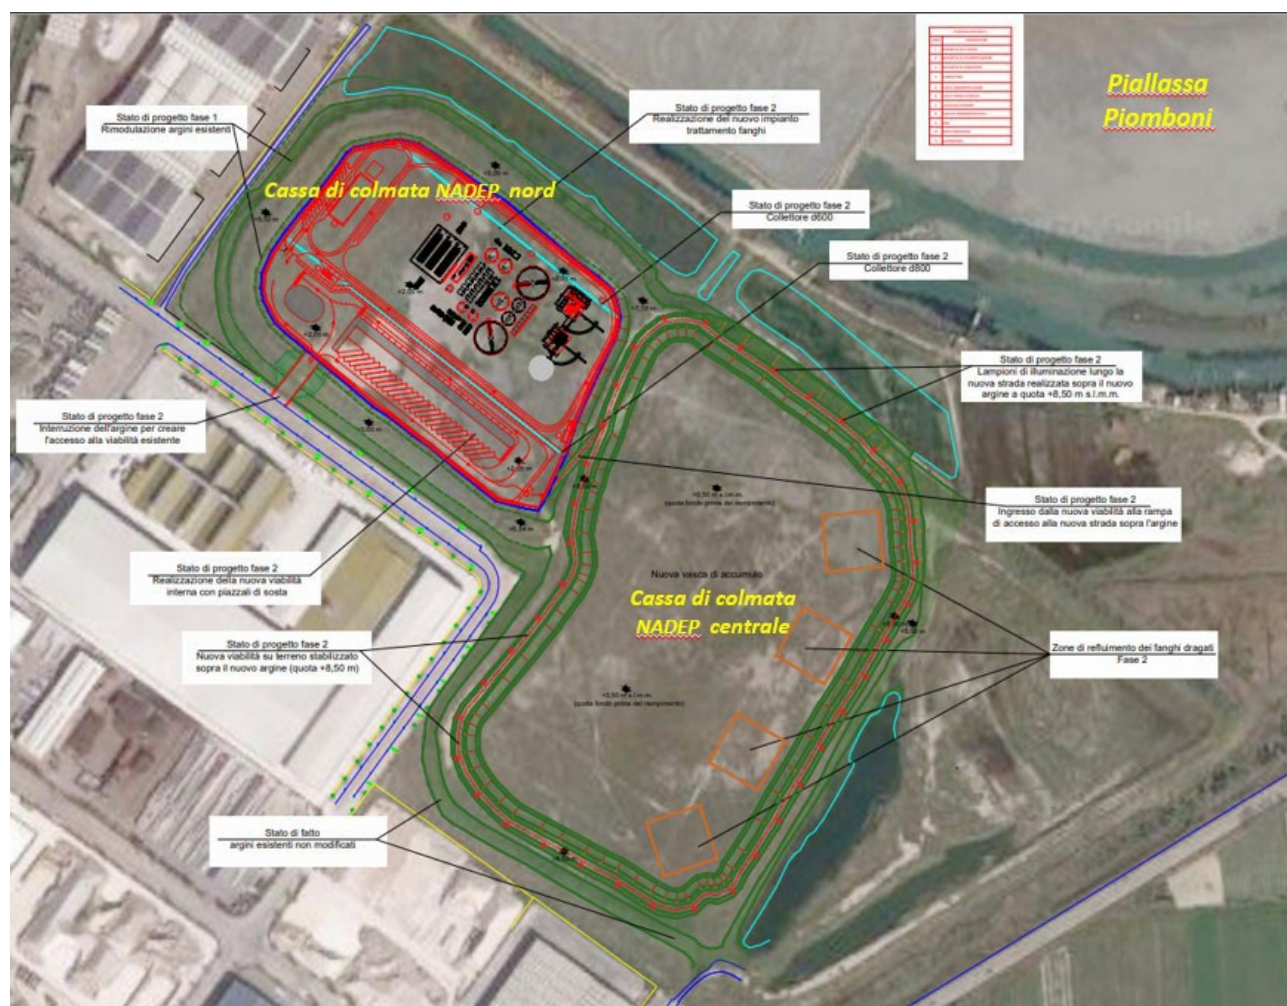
Articolazione progettuale dell'impianto di trattamento
